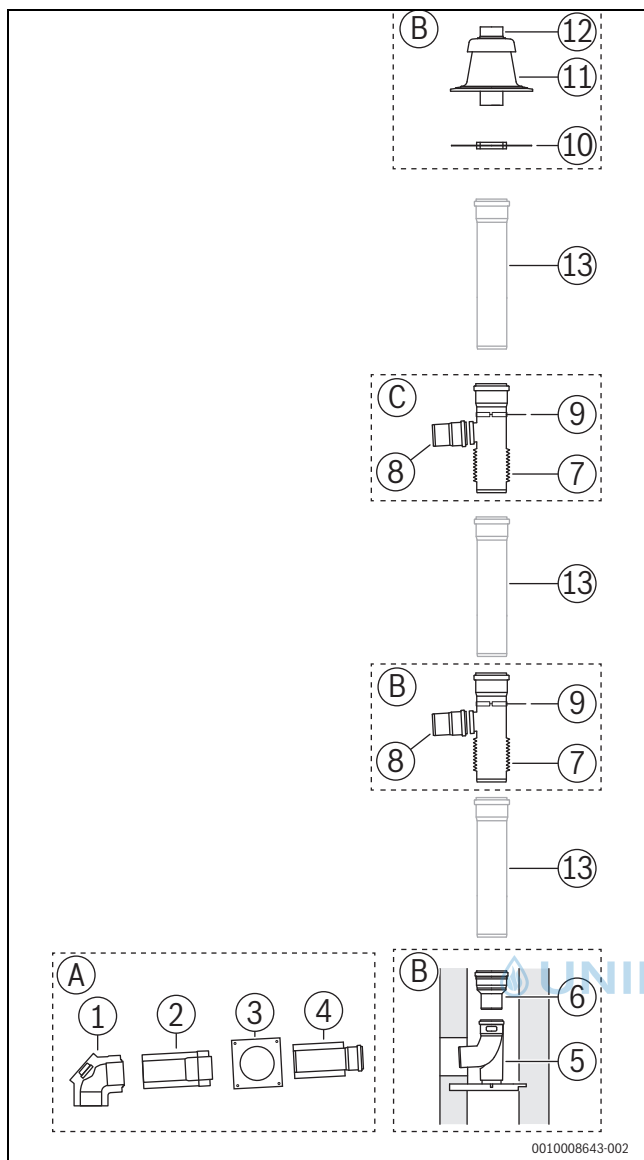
Bauteile des Bausatzes Mehrfachbelegung
